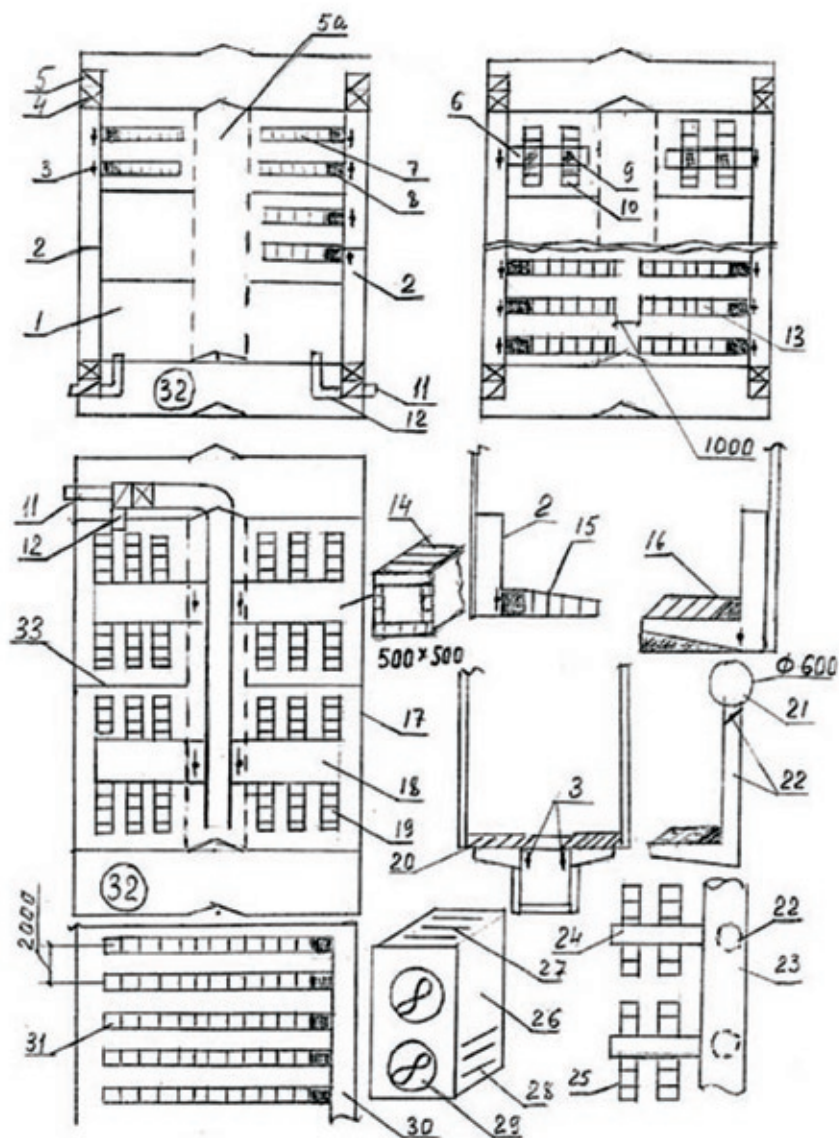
Принципиальные схемы систем вентиляции картофелехранилищ.
